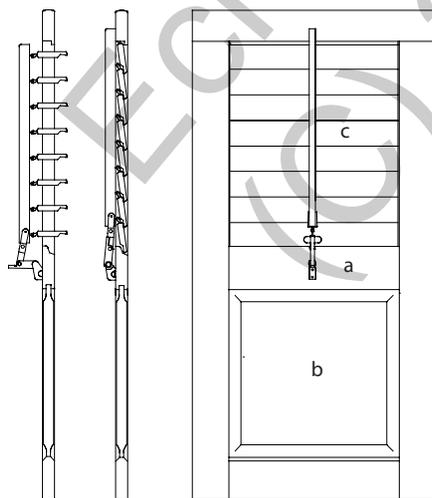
/1115 : Contrevent à lamelles mobiles et panneau plein ; traverse (a), panneau plein (b), lamelles (c)
